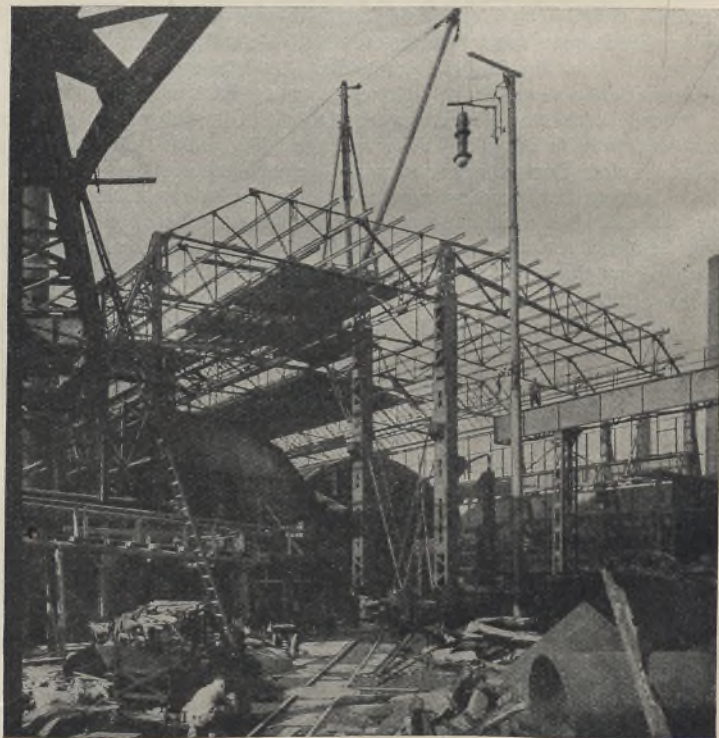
Umbau der Walzwerkshalle eines rheinischen Stahlwerkes. (Einbau der neuen Binder mittels Schwenkkranes.)
